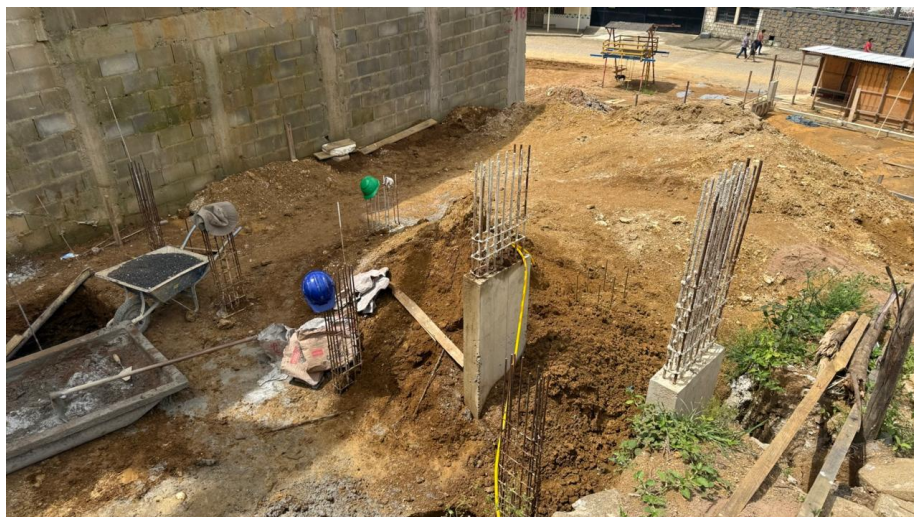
Detalhe para escavação e elementos de fundação da rampa
